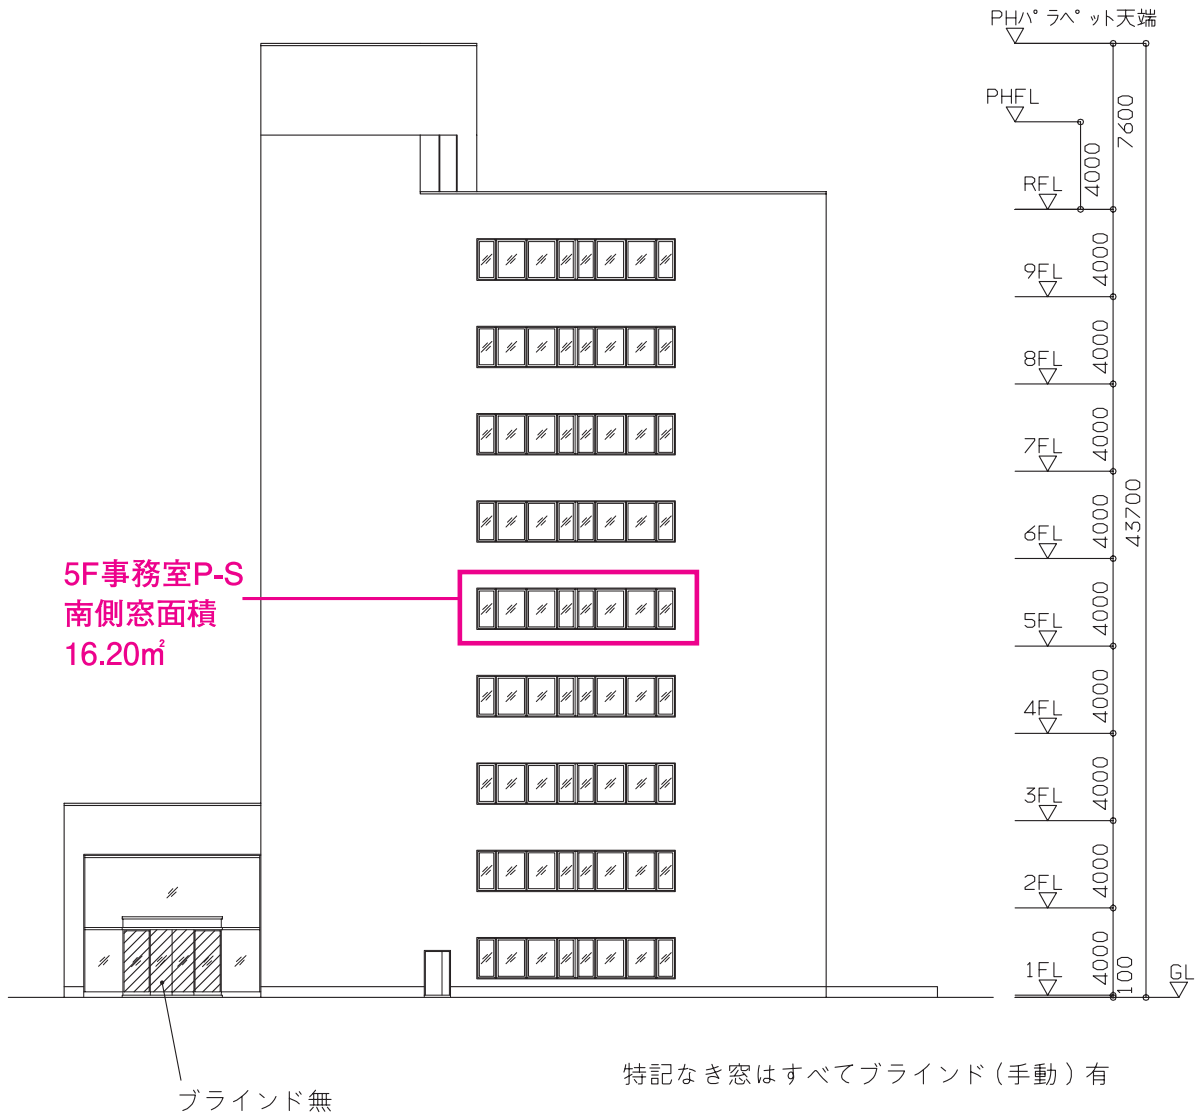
意匠図 立面図 (南) (図面 - 意 - 9)
